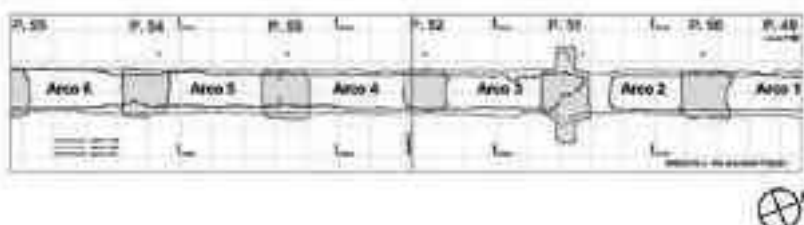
Profili planimetrici del tratto oggetto dell'Attività Ispettiva
